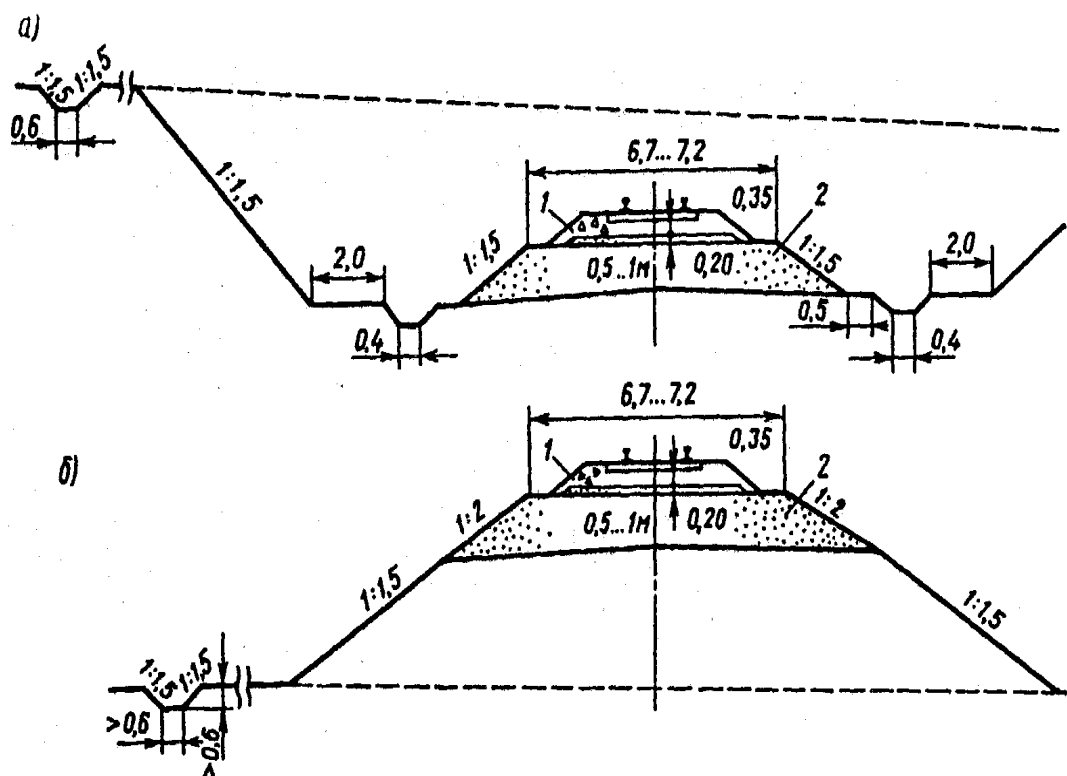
Поперечные профили земляного полотна из глинистых грунтов по нормам СНиП 01-95: а - выемки; б - насыпи; 1 - двухслойная балластная призма; 2 - защитный слой из дренирующего грунта
